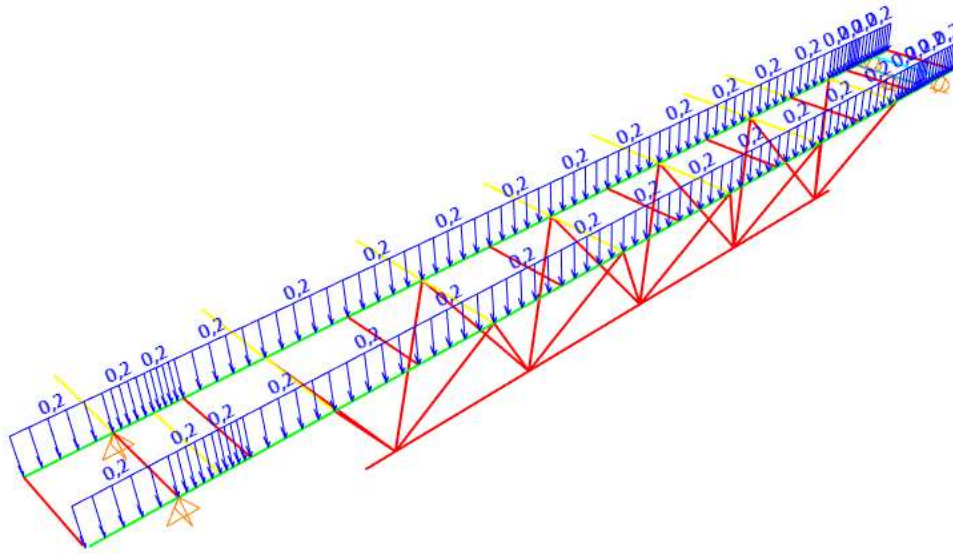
Beban *Handrail* yang diterima Struktur *Catwalk 13
